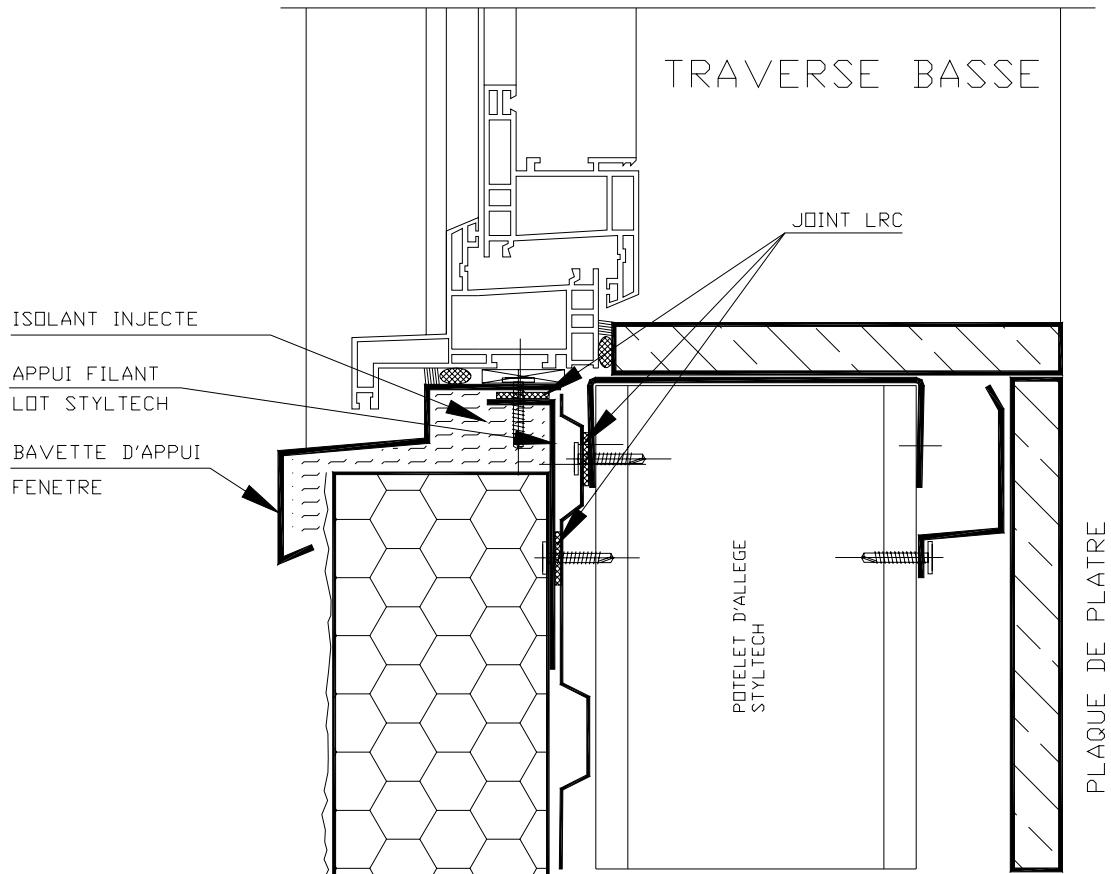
Coupe verticale sur fenêtre – Traverse basse – Menuiserie au nu extérieur
